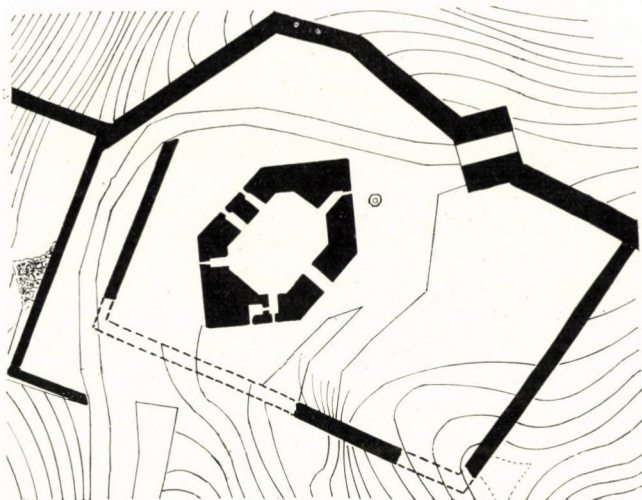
Visegrád. Grundriß des Wohnturmes mit der unteren Burg- und Talspermauer (um 1260)
